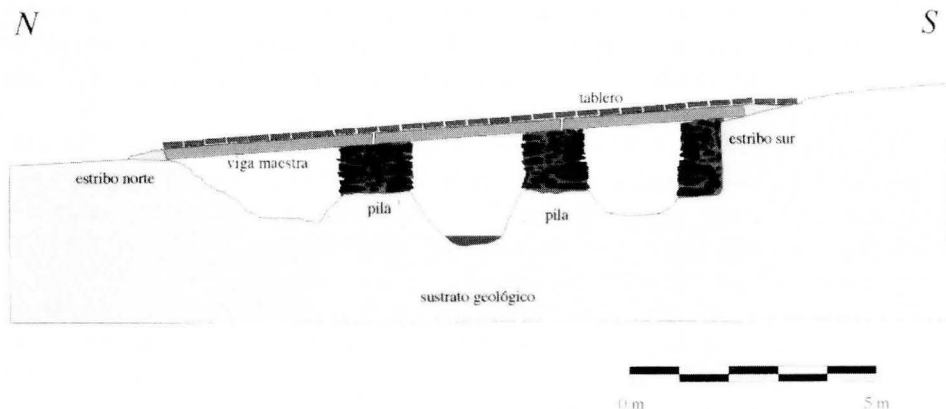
Reconstrucción ideal del puente de entrada, en sección norte-sur.
